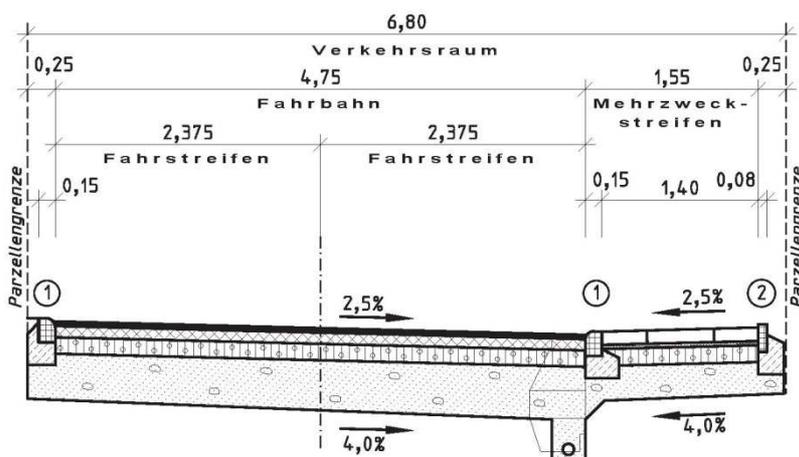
Regelprofil Straßenquerschnitt Haupteerschließungsstraße0 (Planstraßen 1), ohne Maßstab
